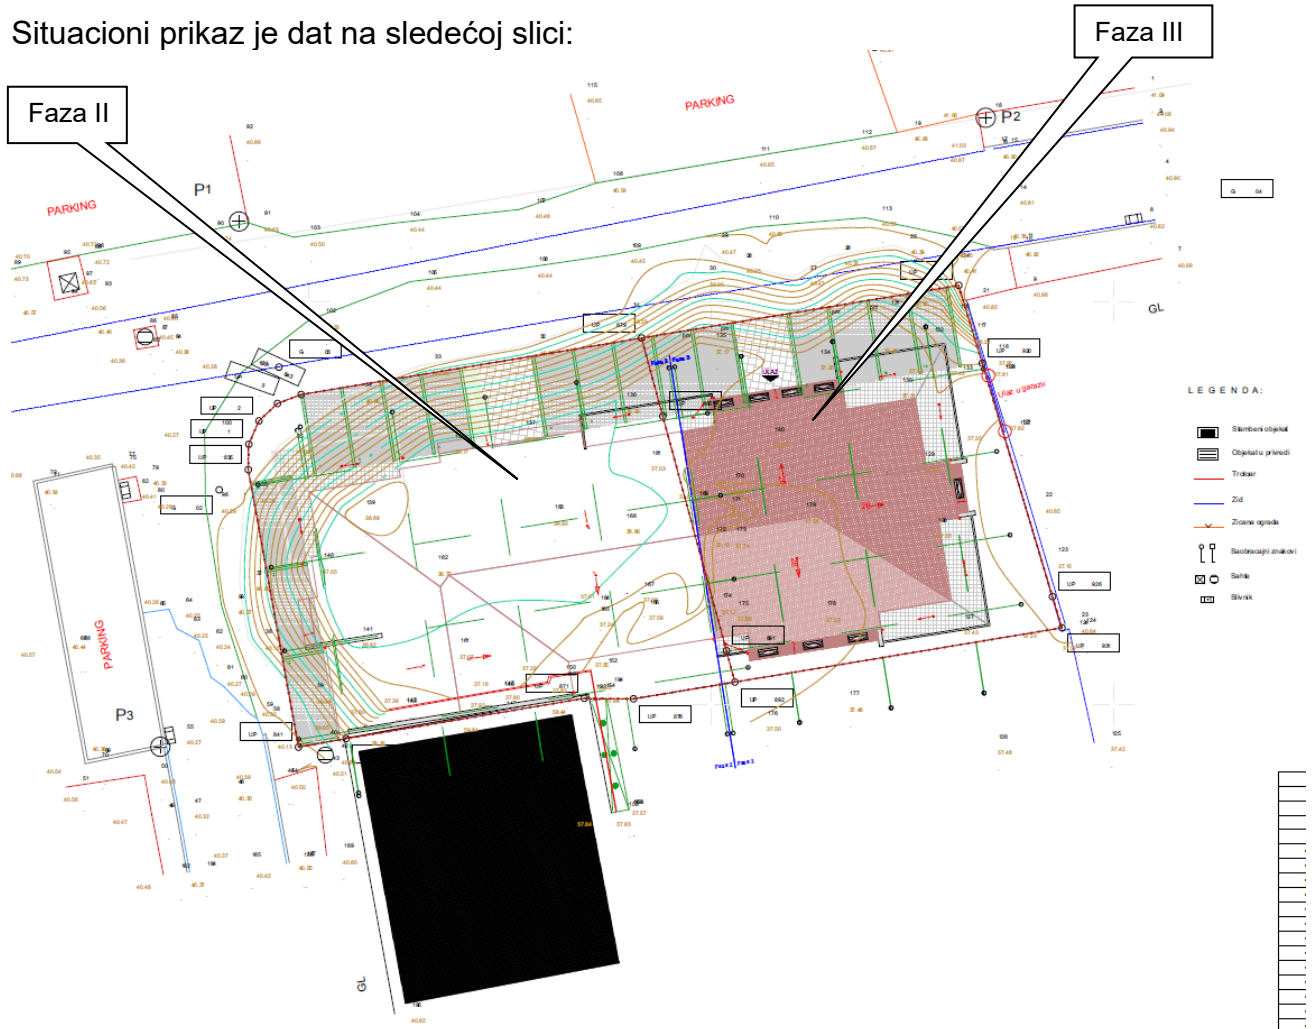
Planirani izgled objekta sa užim okruženjem
